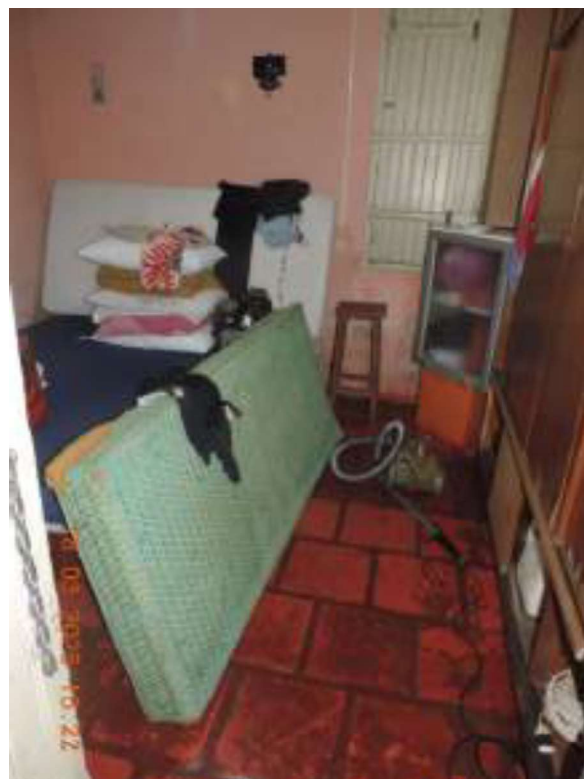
VISTA INTERNA DA EDIFICAÇÃO PRINCIPAL
